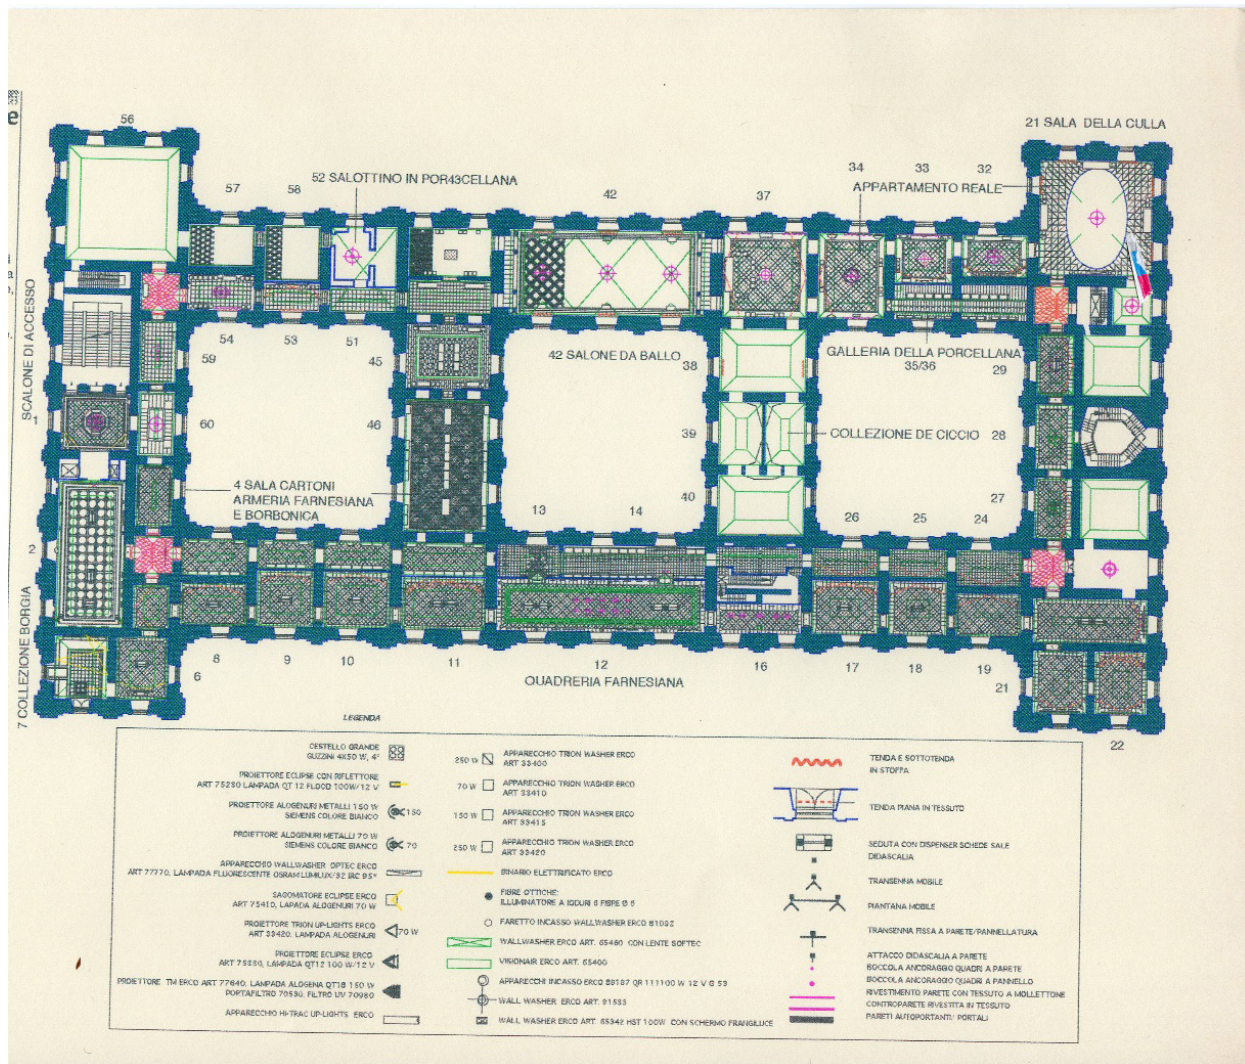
E. Guida, Pianta del primo piano, progetto di restauro e sistemazione della Galleria Farnese, 1994-95. (Per gentile concessione dello Studio Guida)
